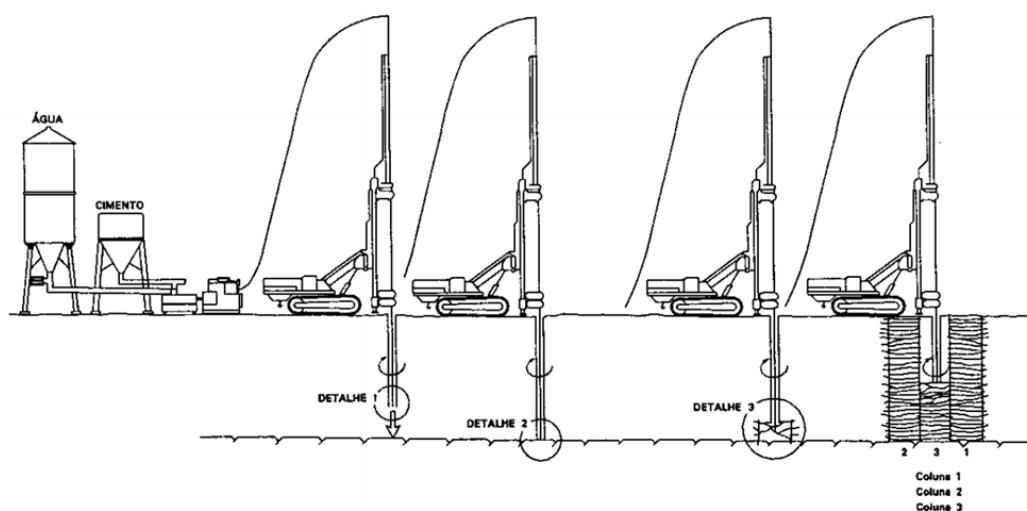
Fases do Jet-Grouting – Fonte: Joana Rodrigues Carreto
